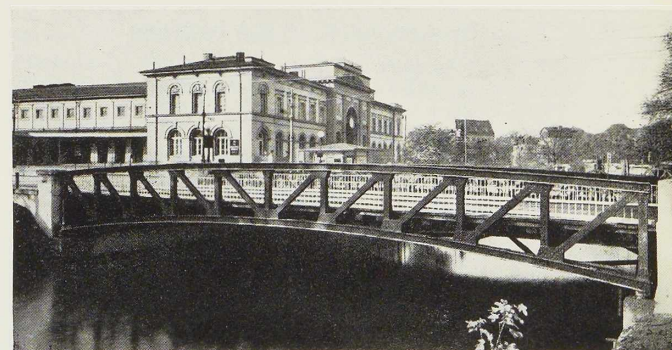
Pont devant la gare centrale de Brunswick. Portée : 21^m8.
